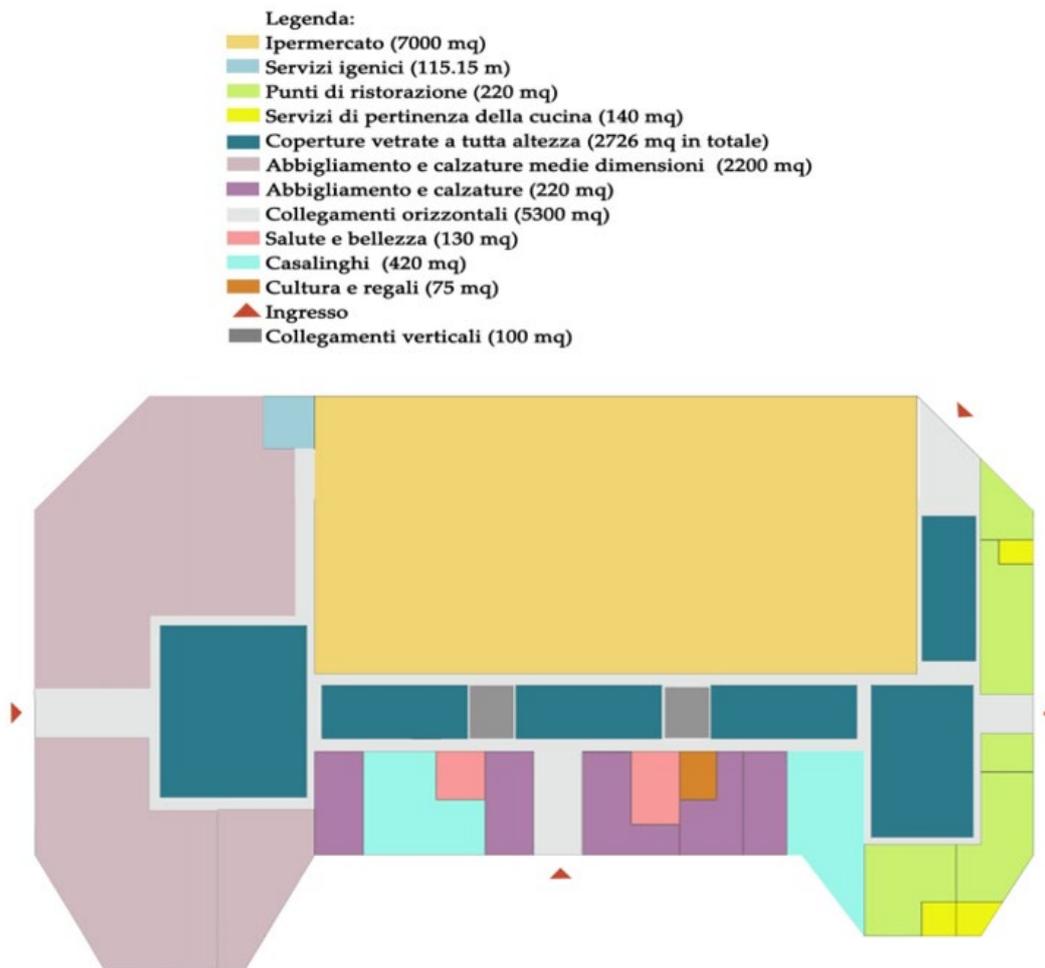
Planimetria del piano terra del centro commerciale tipo con legenda.
